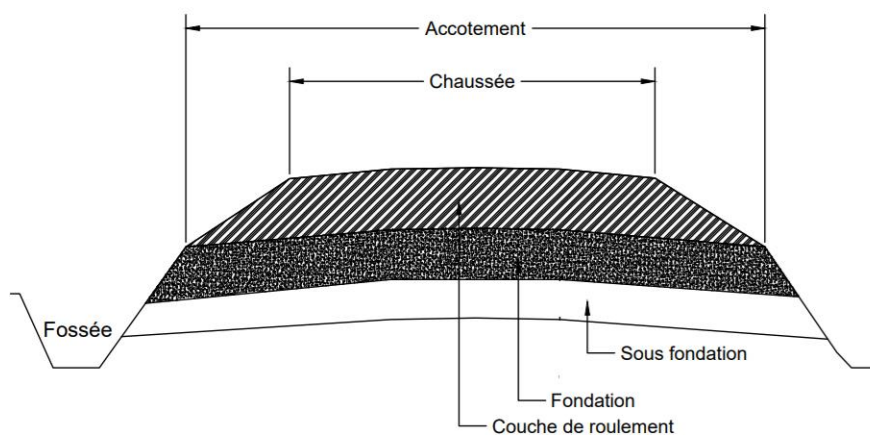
Structure conventionnelle d'une chaussée non revêtue.
